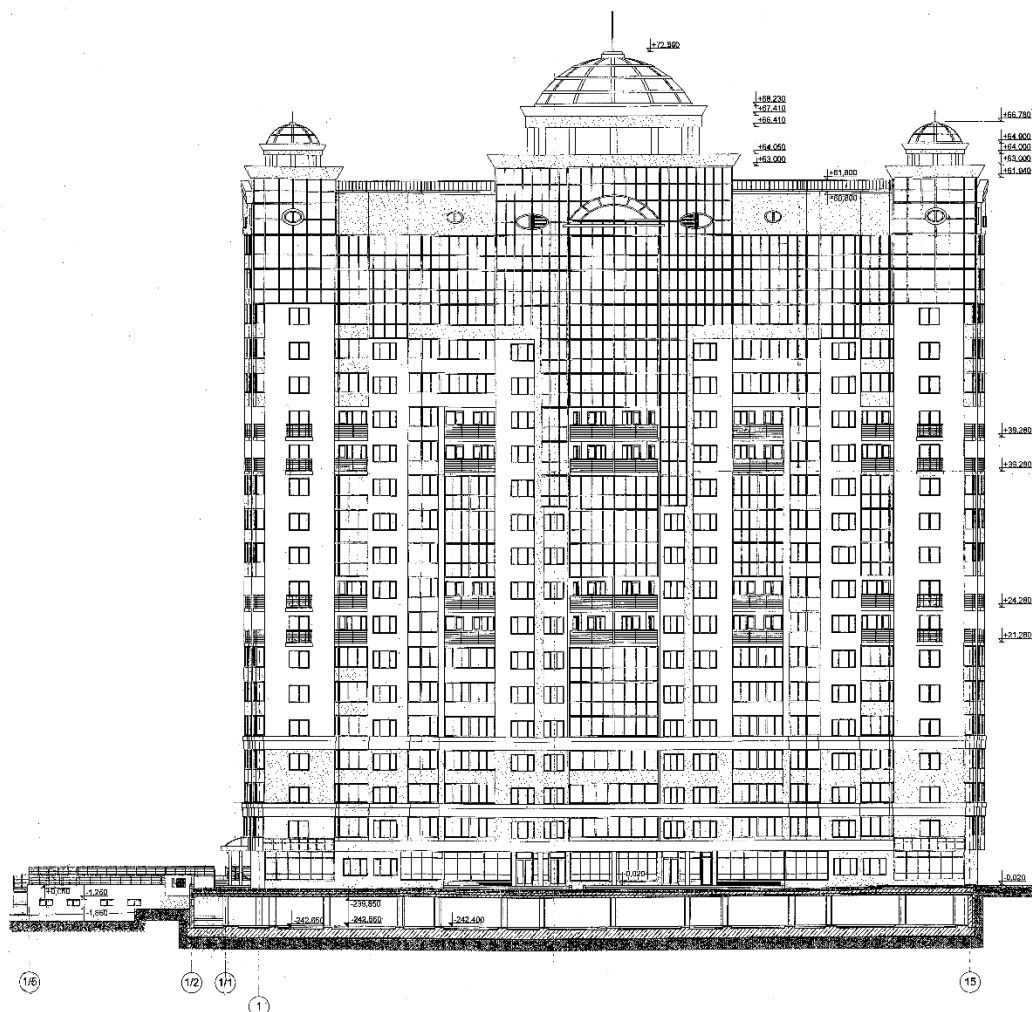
Фасад у всіх «1-15» будівлі «Будинок з ротондами»
